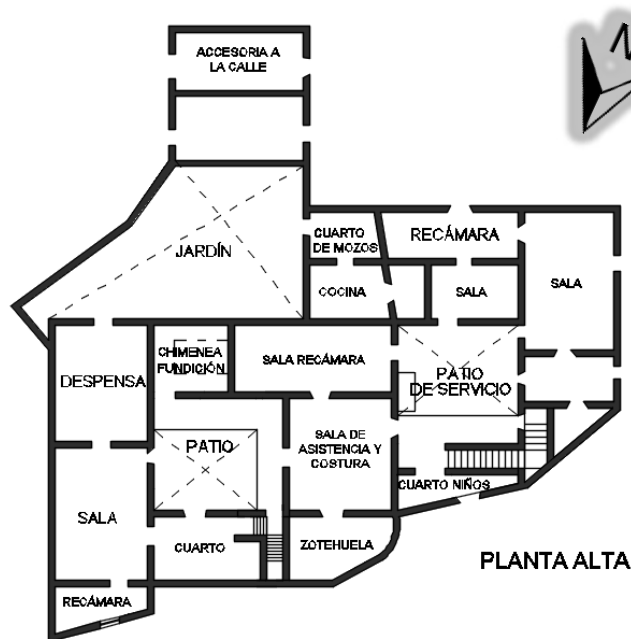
Planta Alta original Casa del Real Ensaye. Dibujó:
